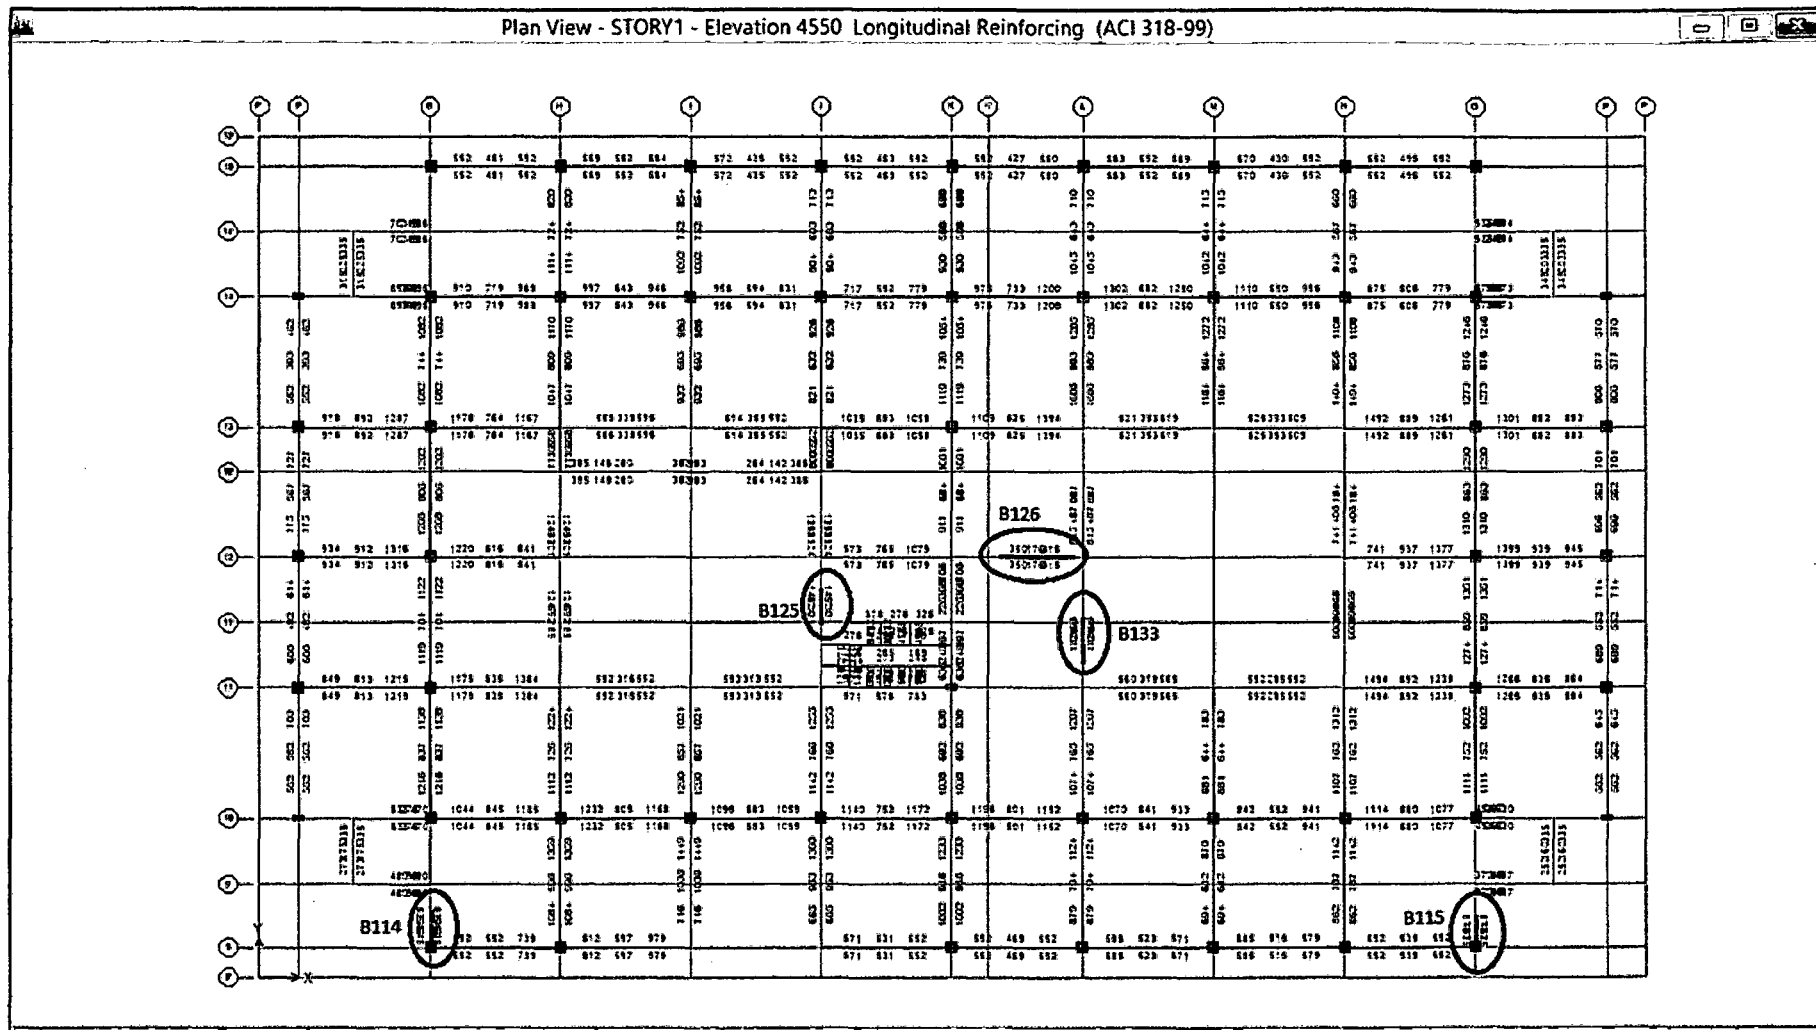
Ubicación de Fallas en Vigas del Primer Nivel
